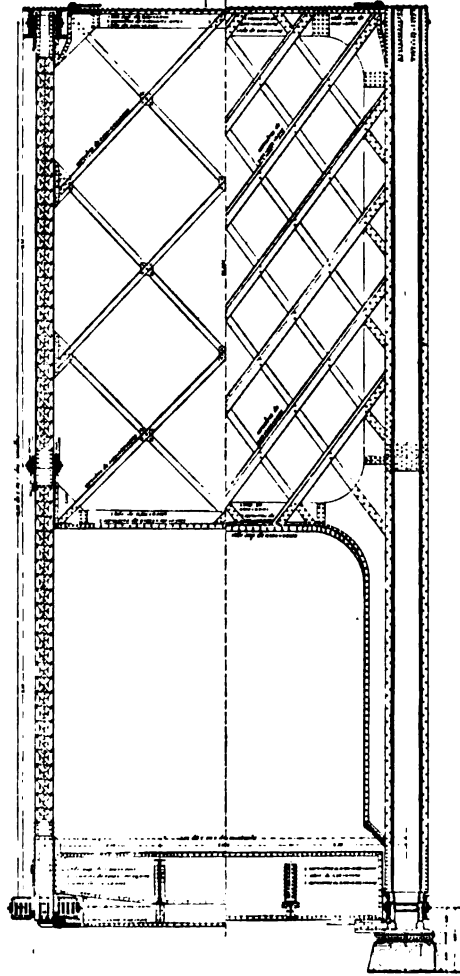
Pont de Caïro. — Portails d'une travée de 158^m,14. — Demi-coupe et demi-élévation extrême.
